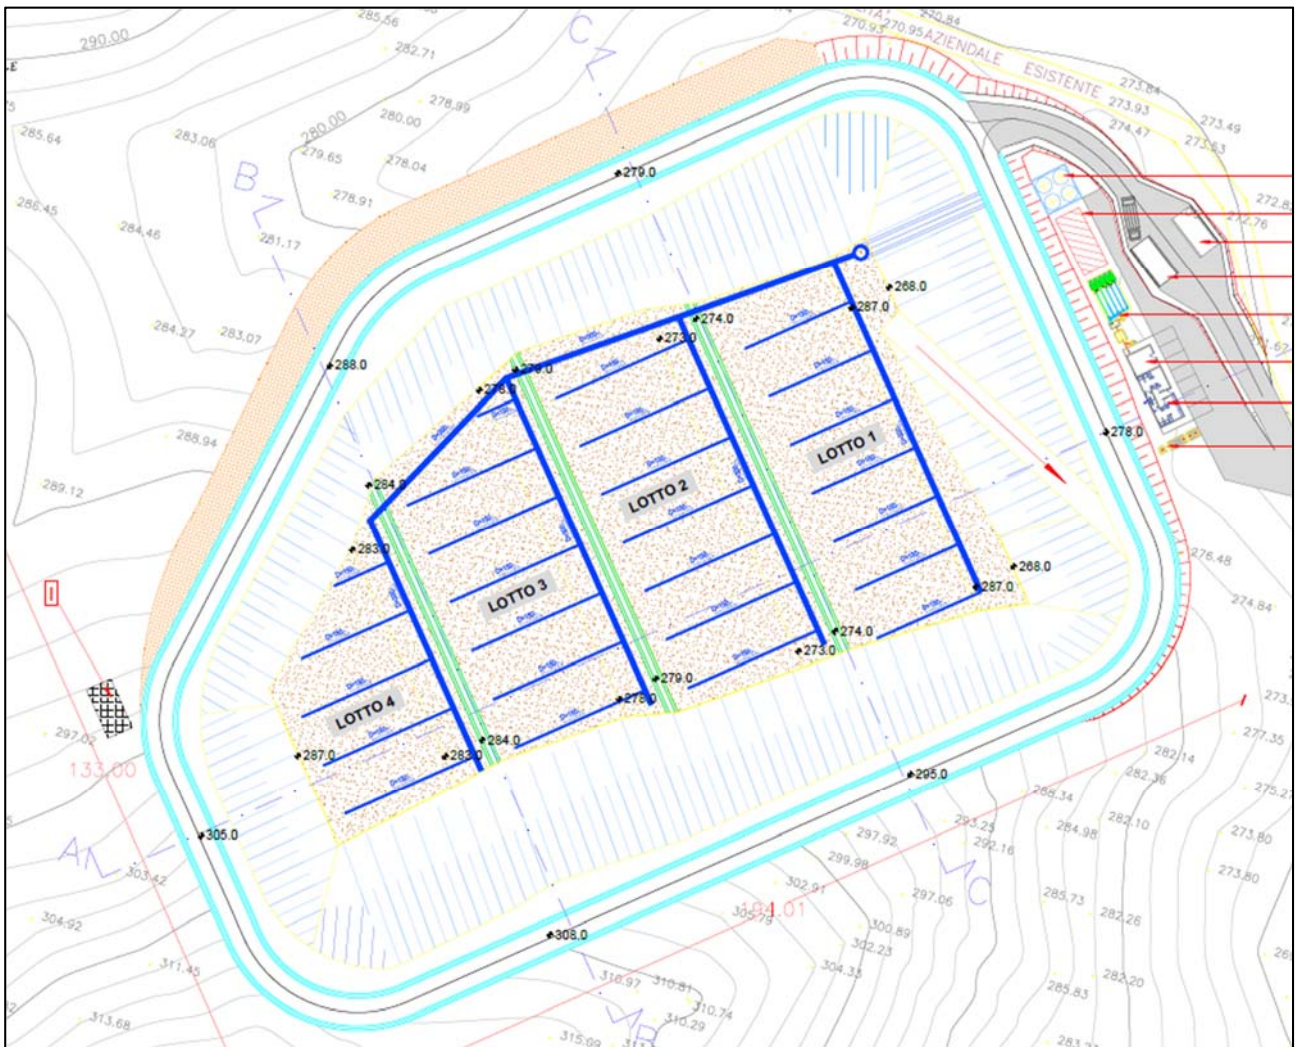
Stralcio All. 22b: planimetria fondovasca
